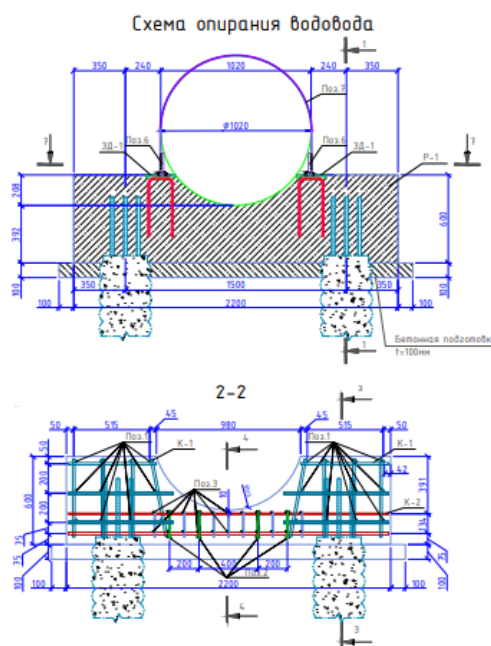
Узел передачи нагрузки от напорного трубопровода $d=1020,0$ мм\ на монолитный железобетонный ростверк.
